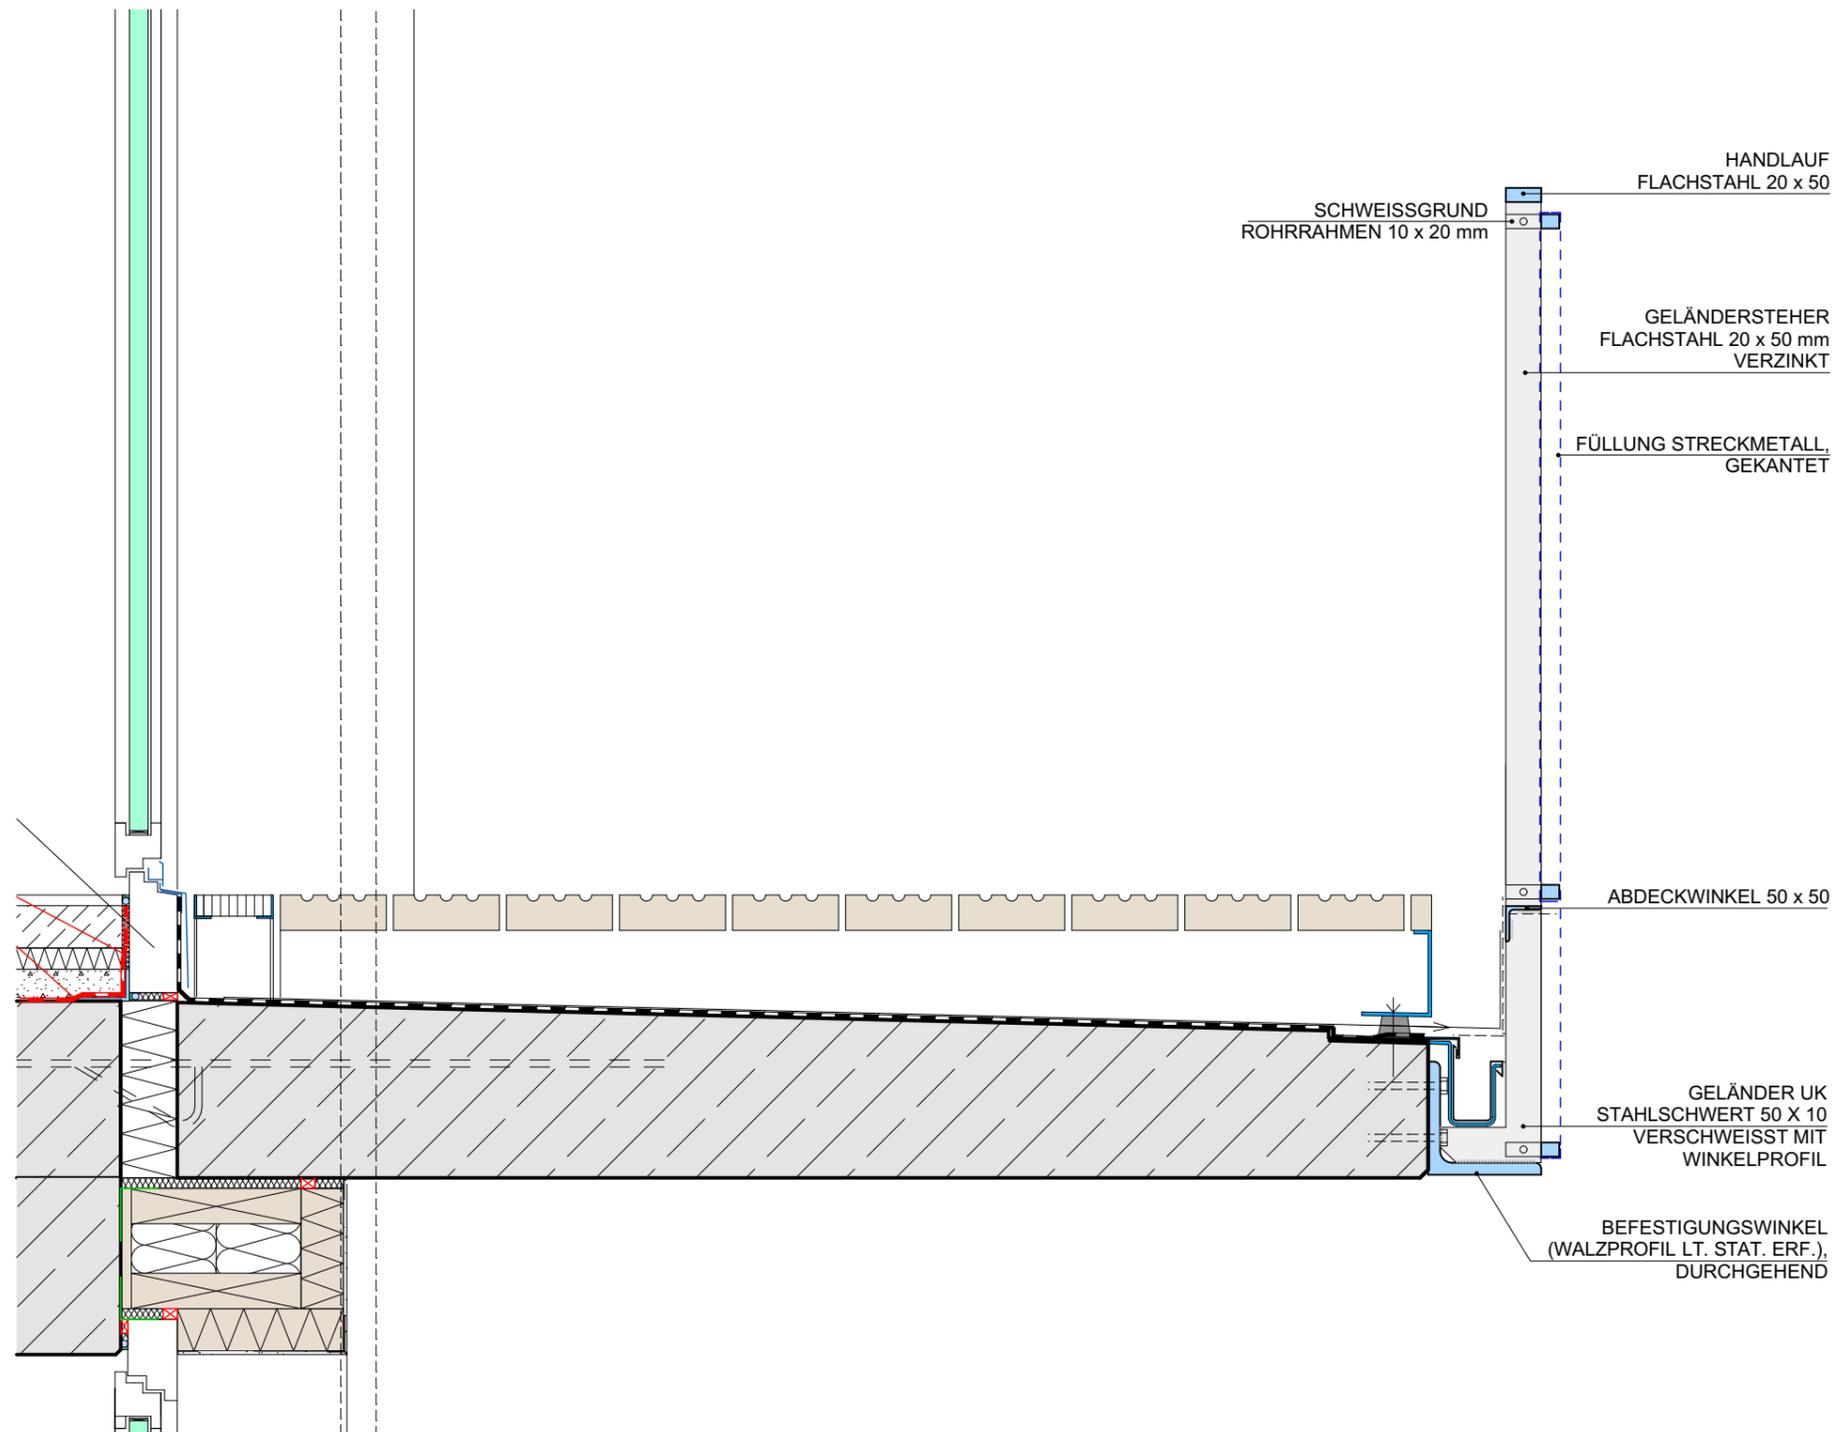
Bauteil 1: Anschluss Balkon1:10
